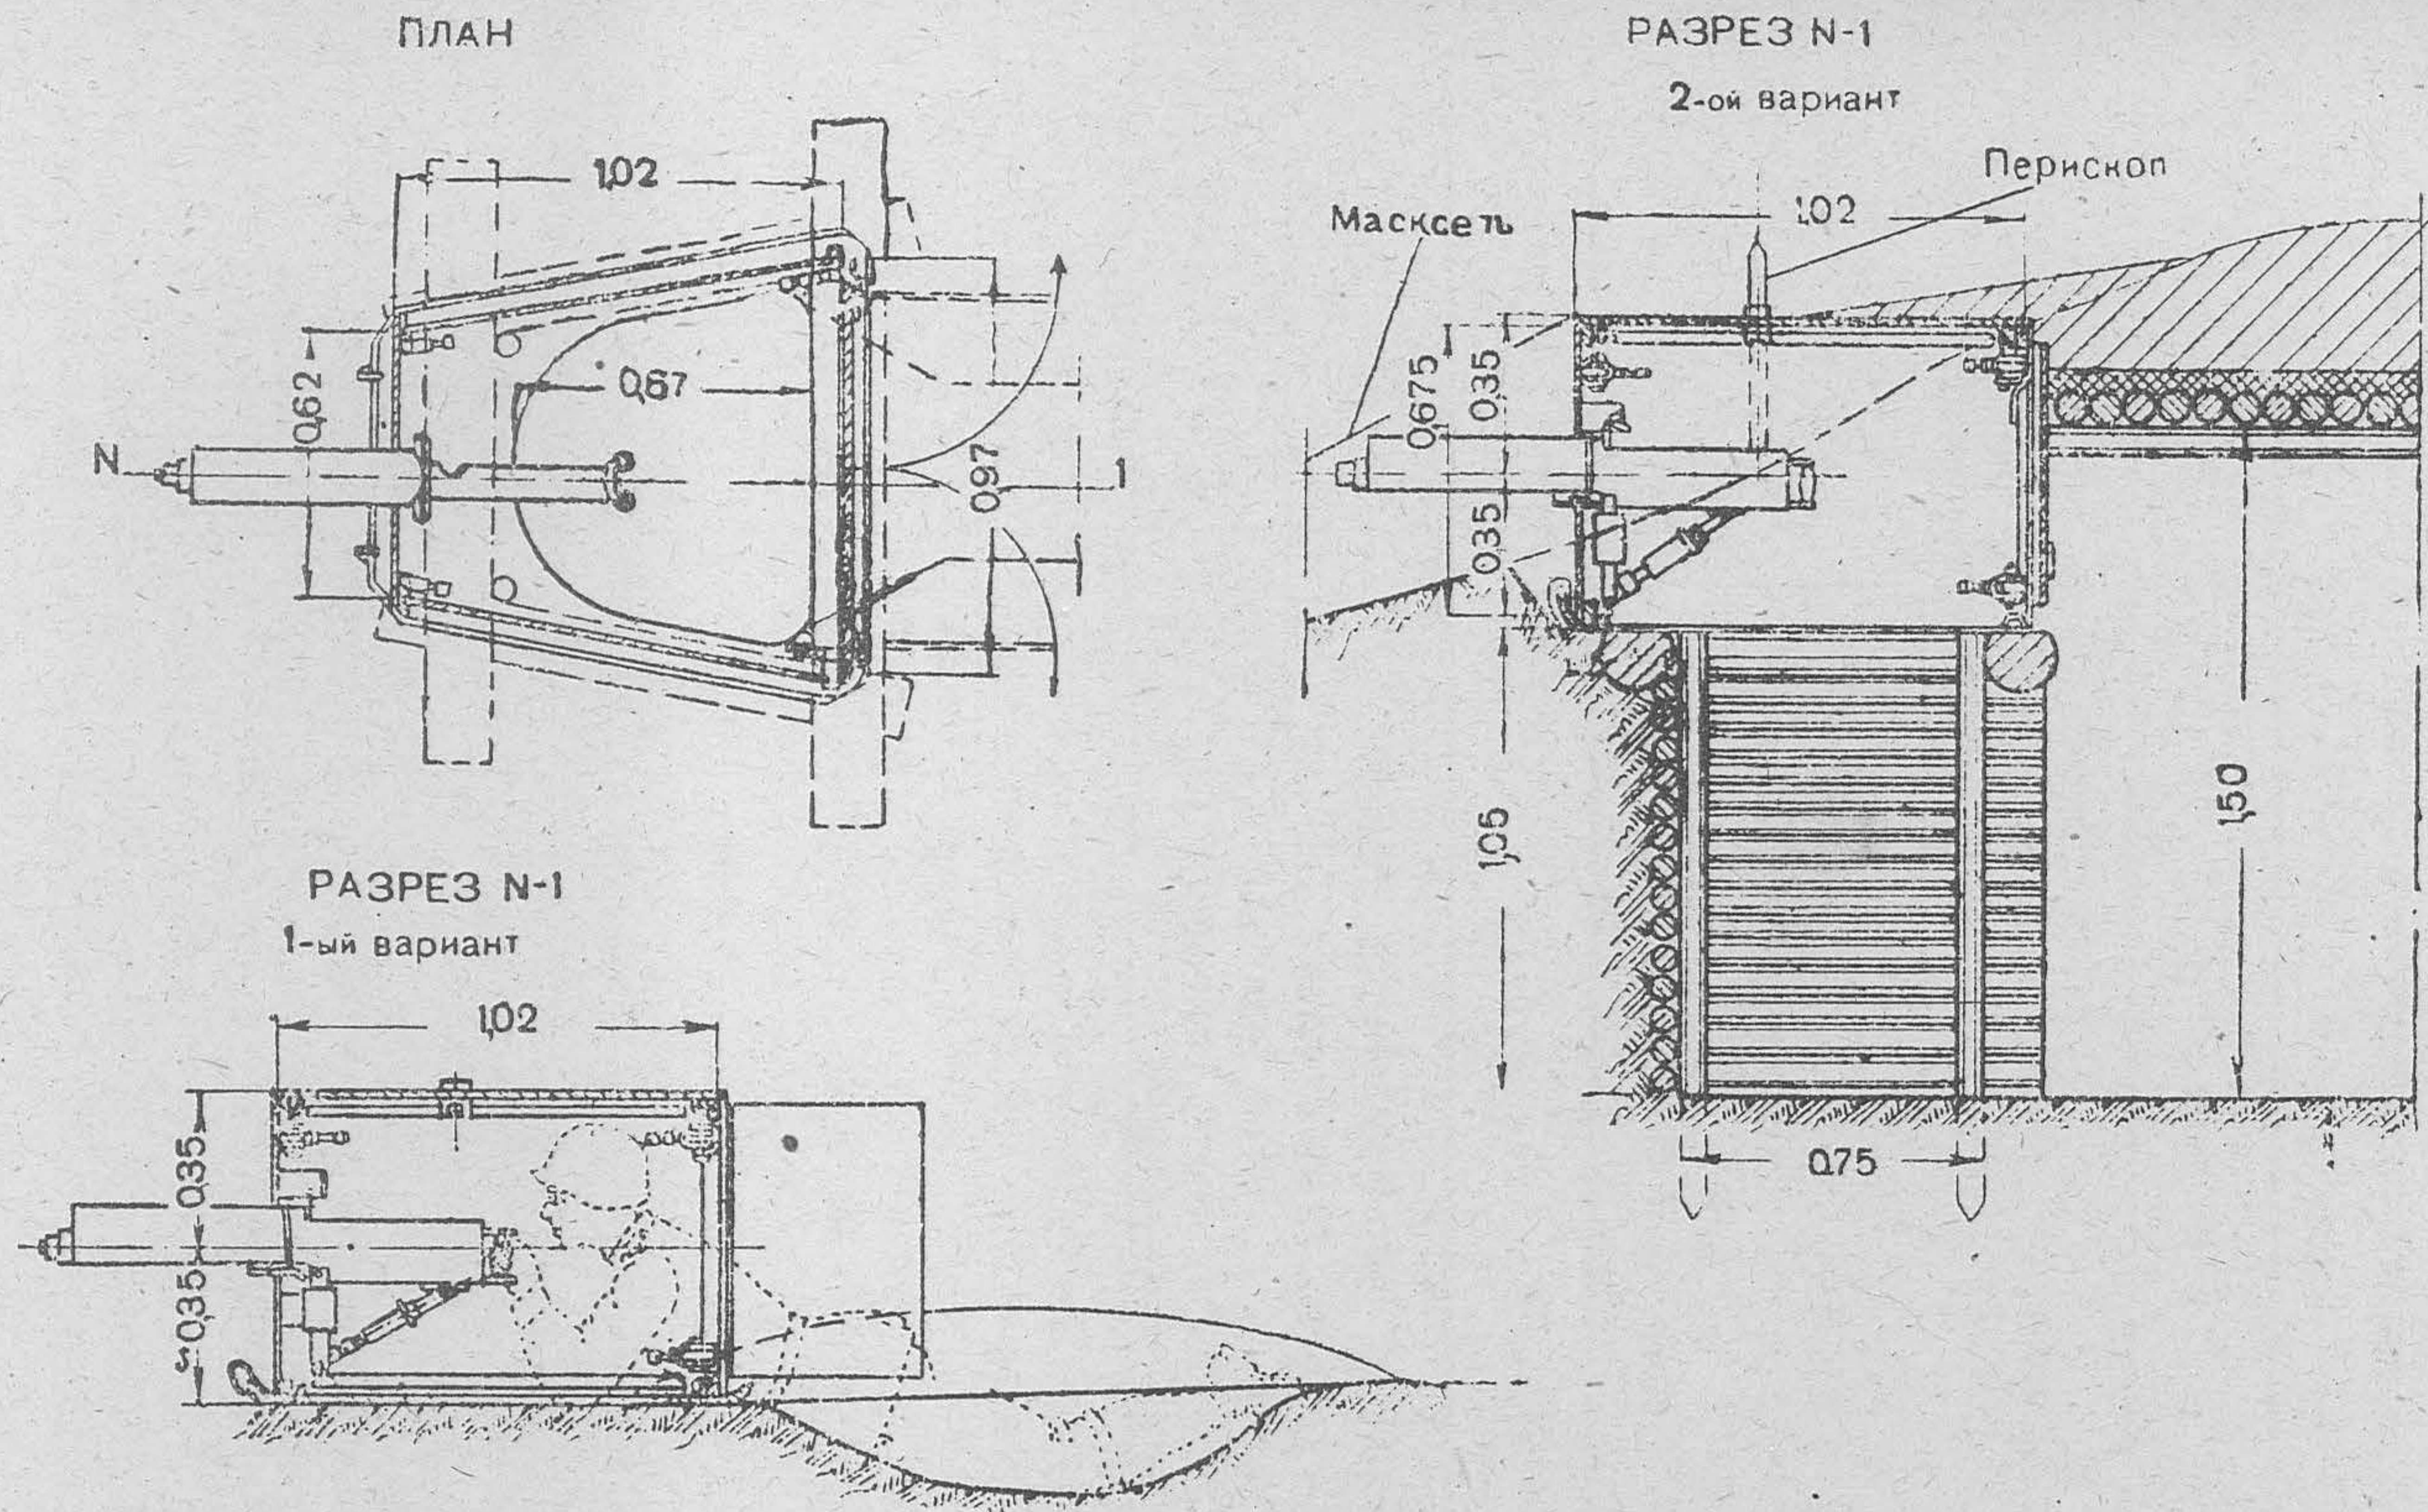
Сборный металлический (броневой) пулемётный колпак противоосколочного типа МНТП при установке для стрельбы лёжа (1-й вариант) и стоя (2-й вариант)
